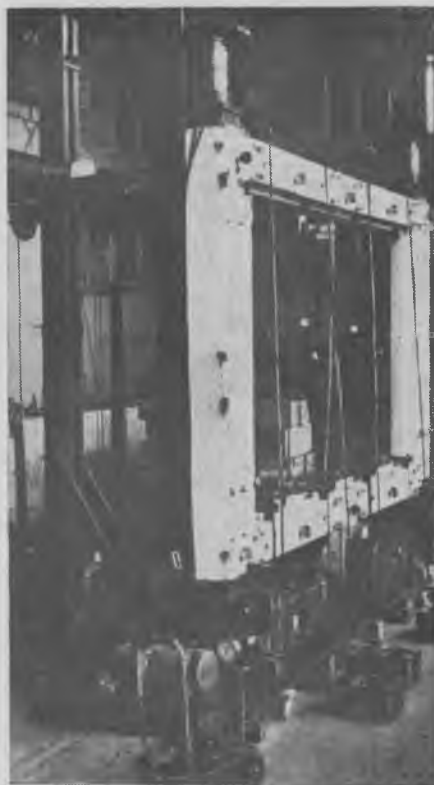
Испытания однослойной укрупненной стеновой панели размером 3×6 м из легкого бетона для стен промышленных зданий
